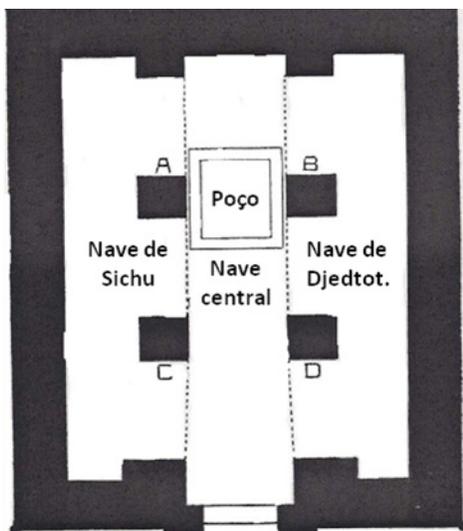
Planta da Capela do túmulo de Petosíris: O poço, os 4 pilares (A-D) e as 3 secções ou naves.
